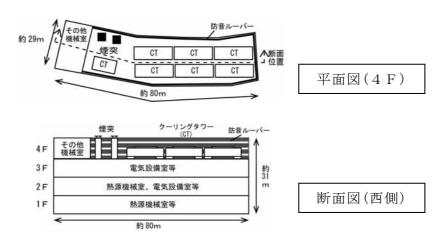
(2) エネルギー施設 B の平面図及び断面図
